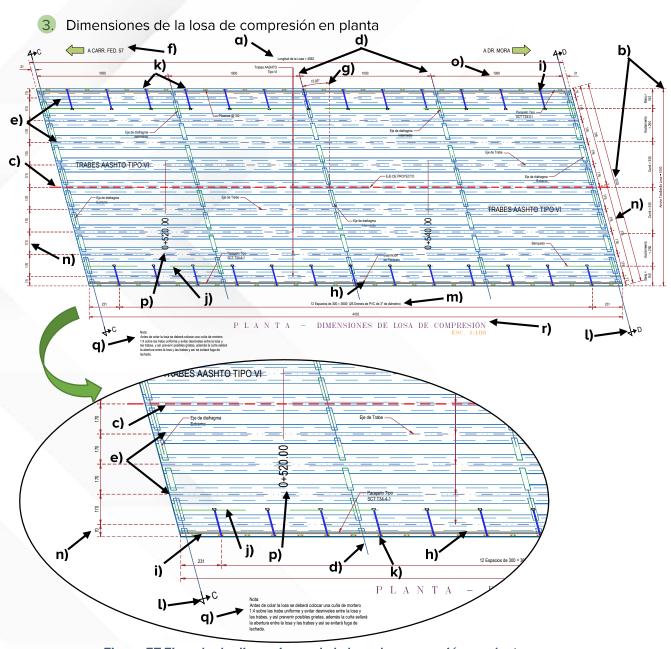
Ejemplo de dimensiones de la losa de compresión en planta
